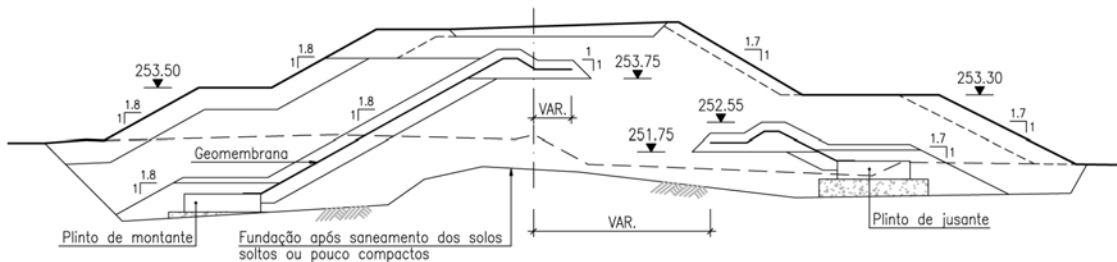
Perfil transversal tipo do alteamento da barragem de Monte Branco nos encontros
